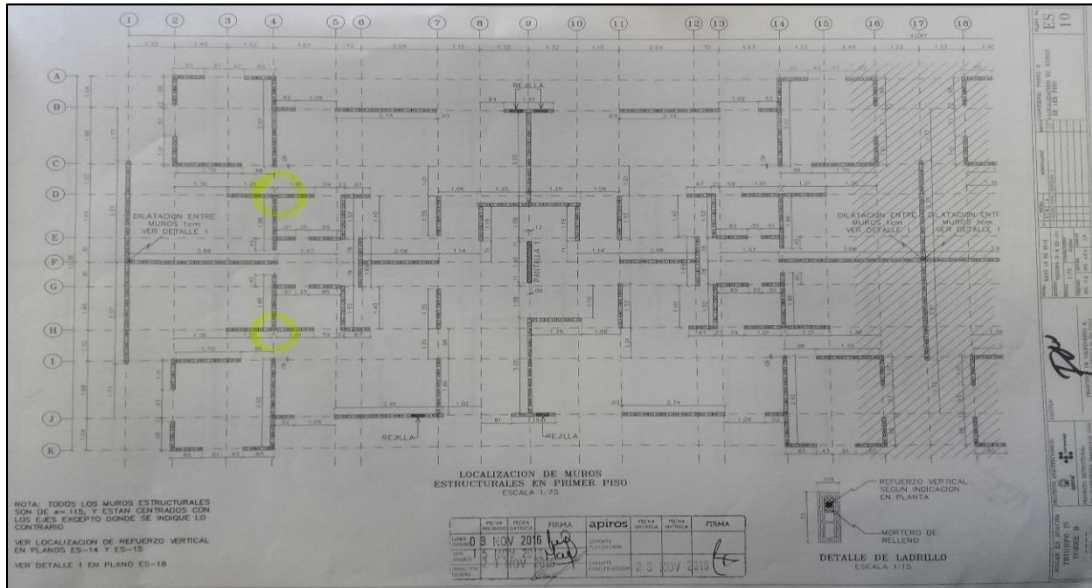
PLANO ESTRUCTURALES ES 10- ES 11 DE LOCALIZACIÓN DE MUROS ESTRUCTURALES 1ER PISO
